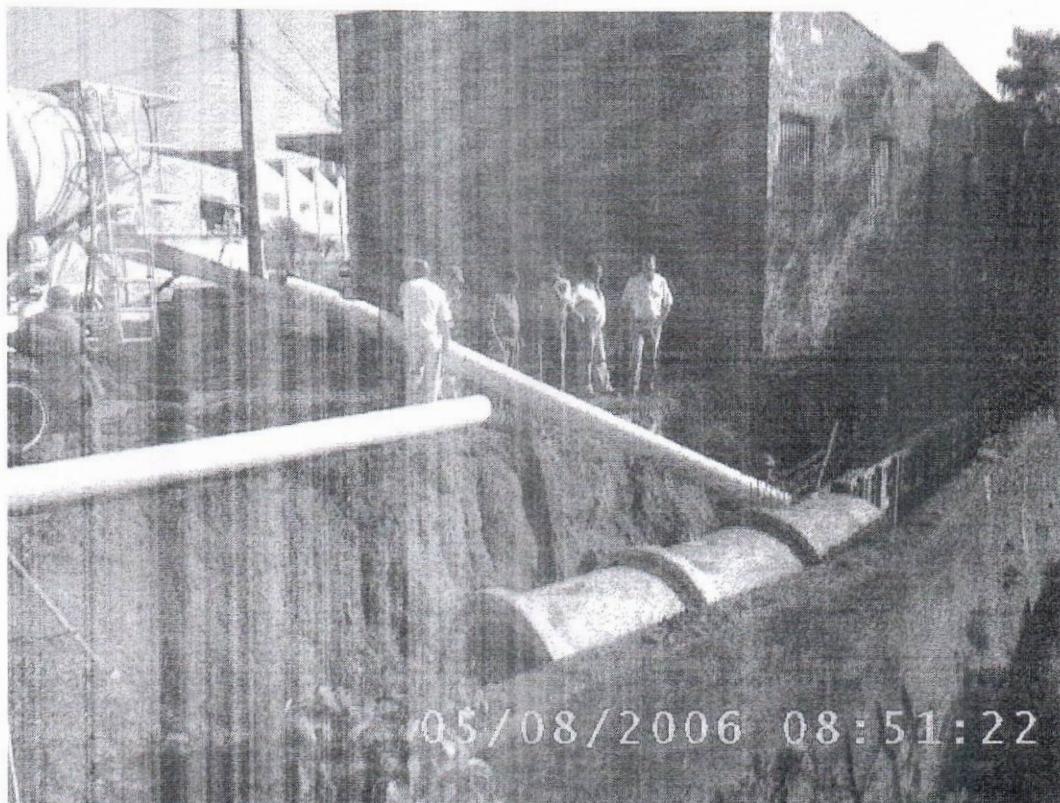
Galeria executada entre as Ruas Anhanguera e Rua Fundadores
